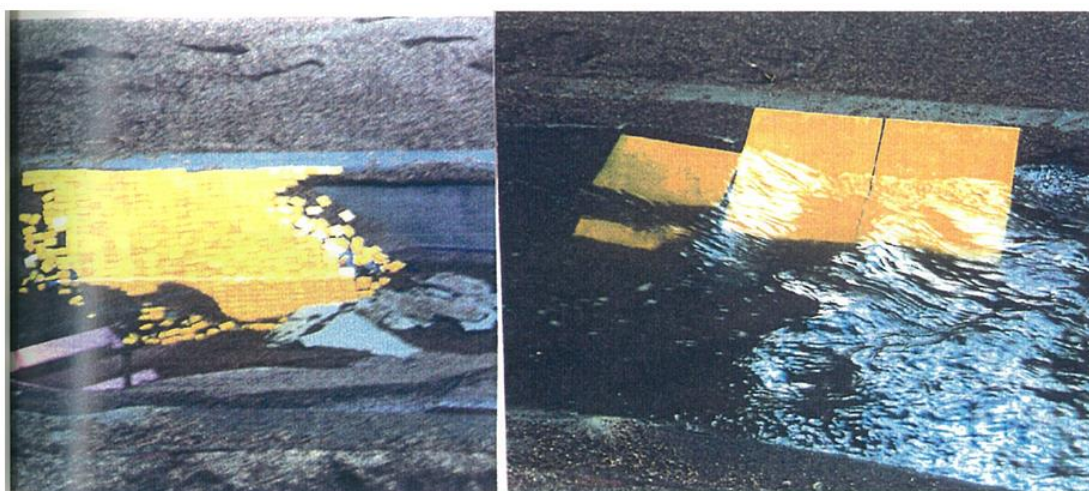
基礎からの破壊 一体性強弱による応答の違い
